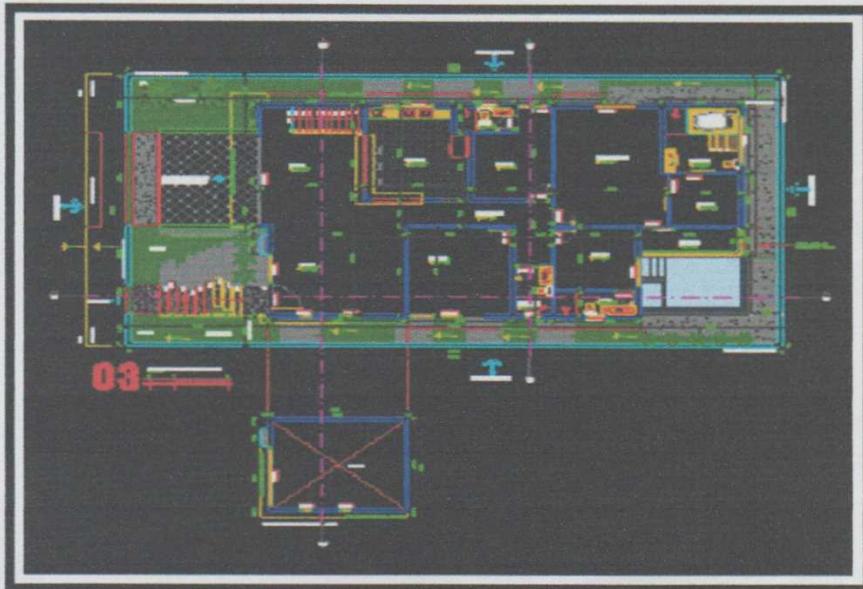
Desenvolvimento de planta baixa utilizando a ferramenta CAD
